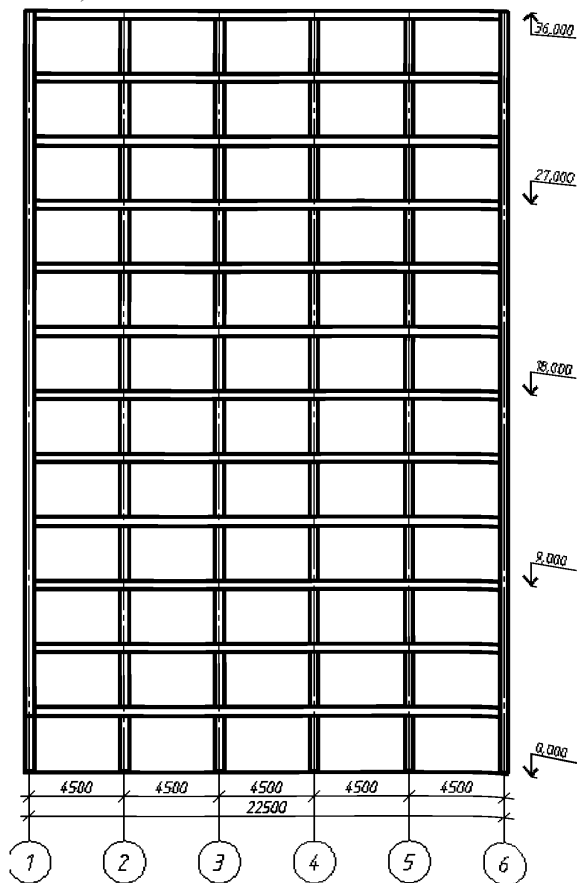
Продольный разрез здания с монолитным железобетонным каркасом
